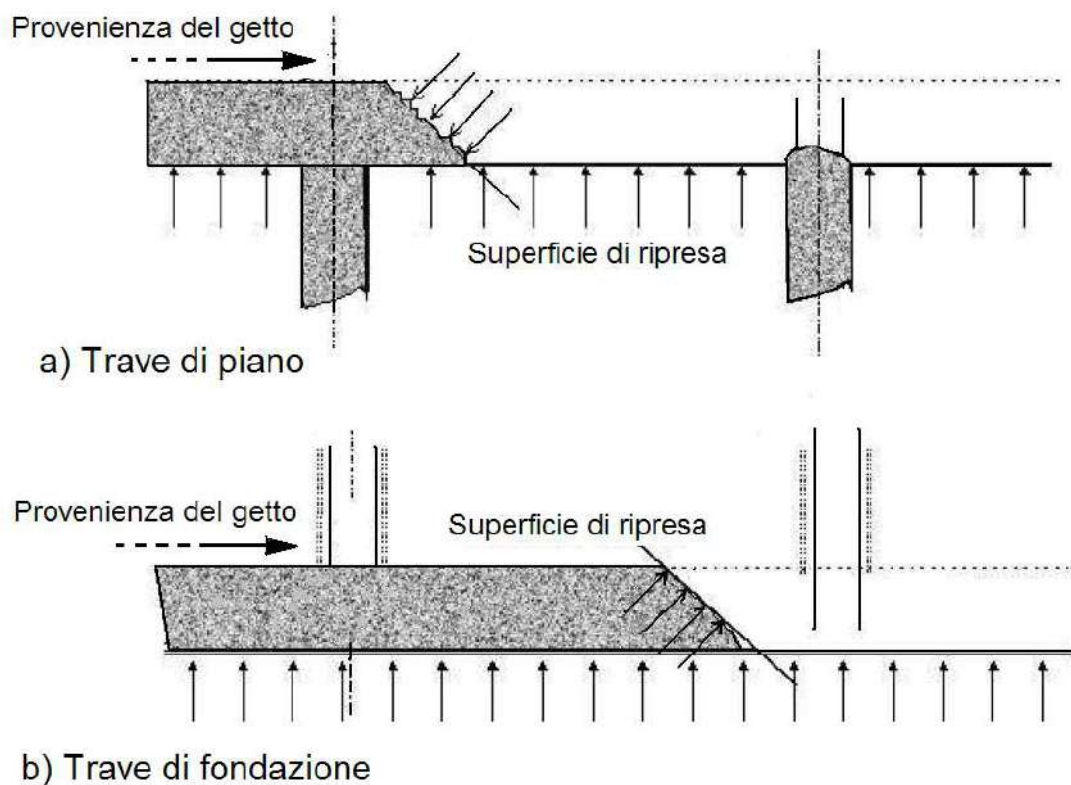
Modalità di ripresa del getto in travi di piano e di fondazione
